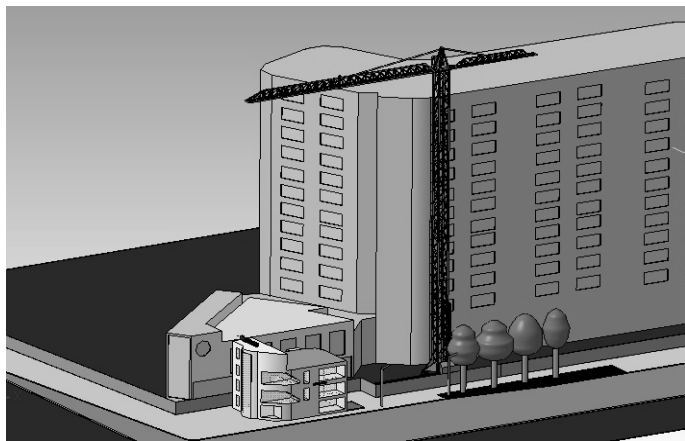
Башенный кран КБ-674 на строительстве жилого комплекса
